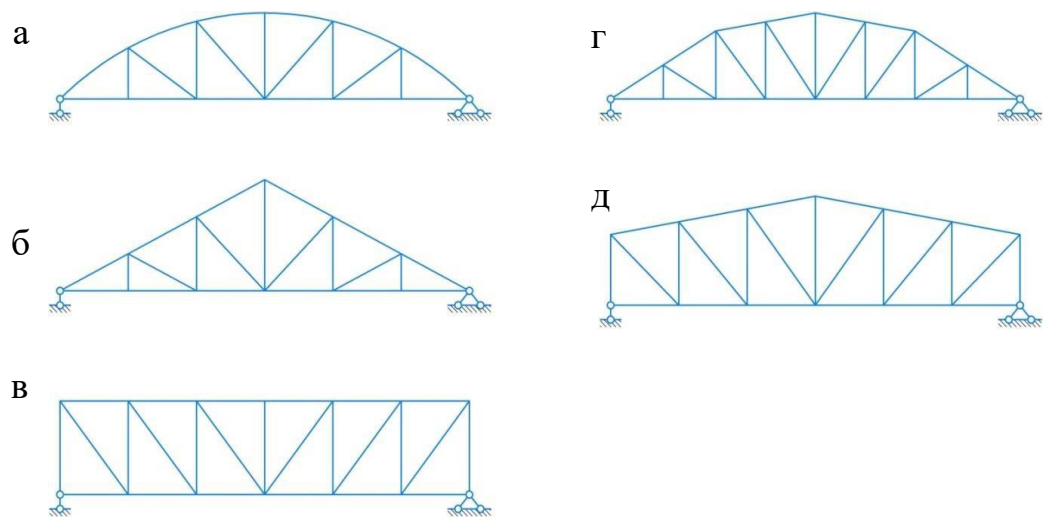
Очертания поясов ферм: *а – сегментное; б – треугольное; в – параллельными поясами; г – полигональная; д – трапецидальная
